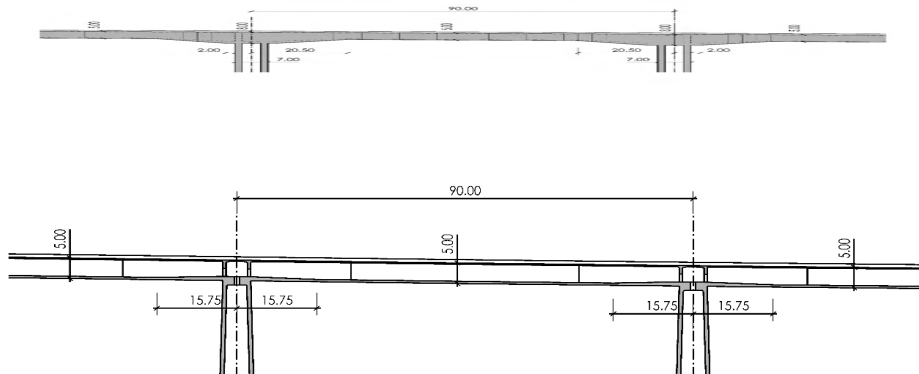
Alzado de un vano tipo de 90m – solución original de voladizos (en cima); alternativa vano a vano (abajo).
